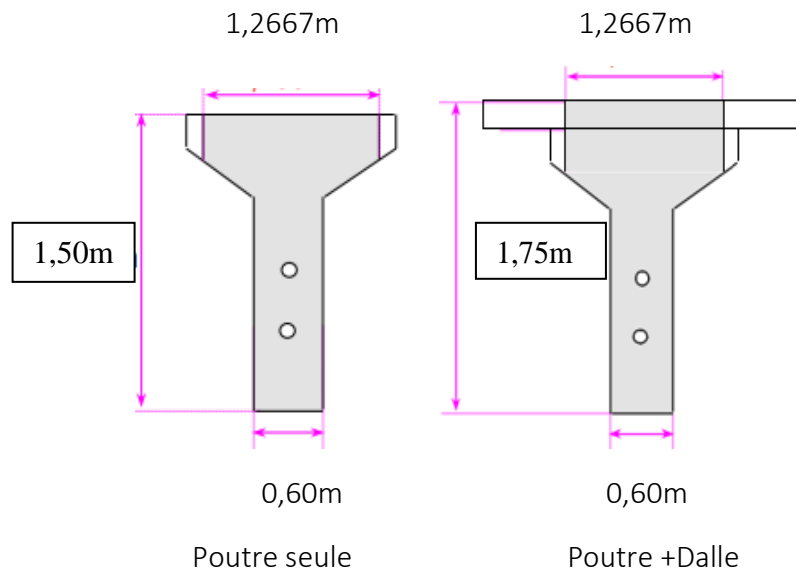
Section nette de la section homogène (Poutre seule et Poutre+Dalle).
